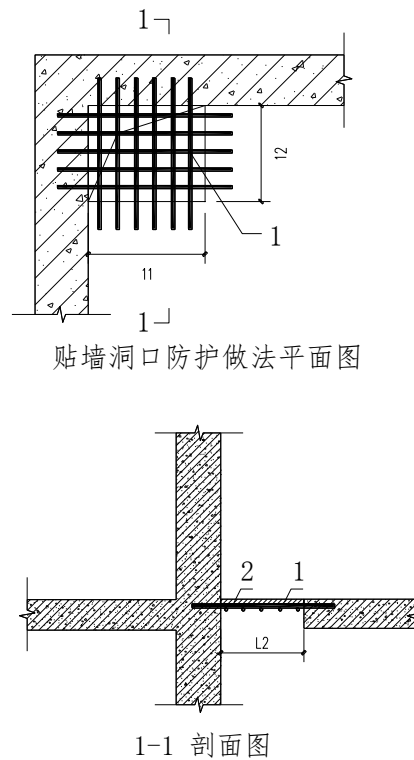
洞口贴墙时的防护做法示意图（单位：mm）
